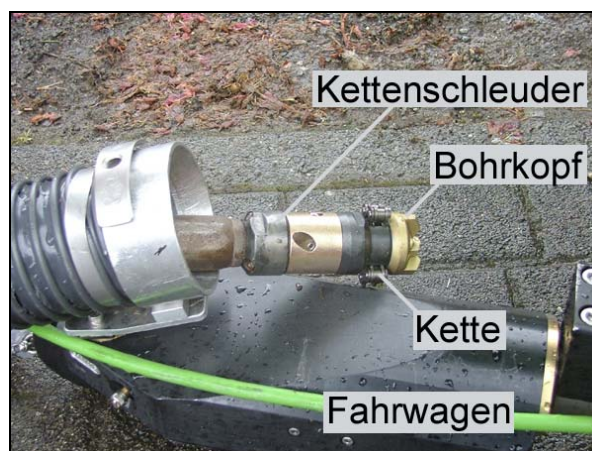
HD-Kettenschleuder im SPE-System [20]. Die Kettenschleuder besitzt neben rückwärts gerichteten Düsen für den Vortrieb einen frontalen Bohrkopf und Ketten die durch den Wasserdruck in Rotation gebracht werden.
